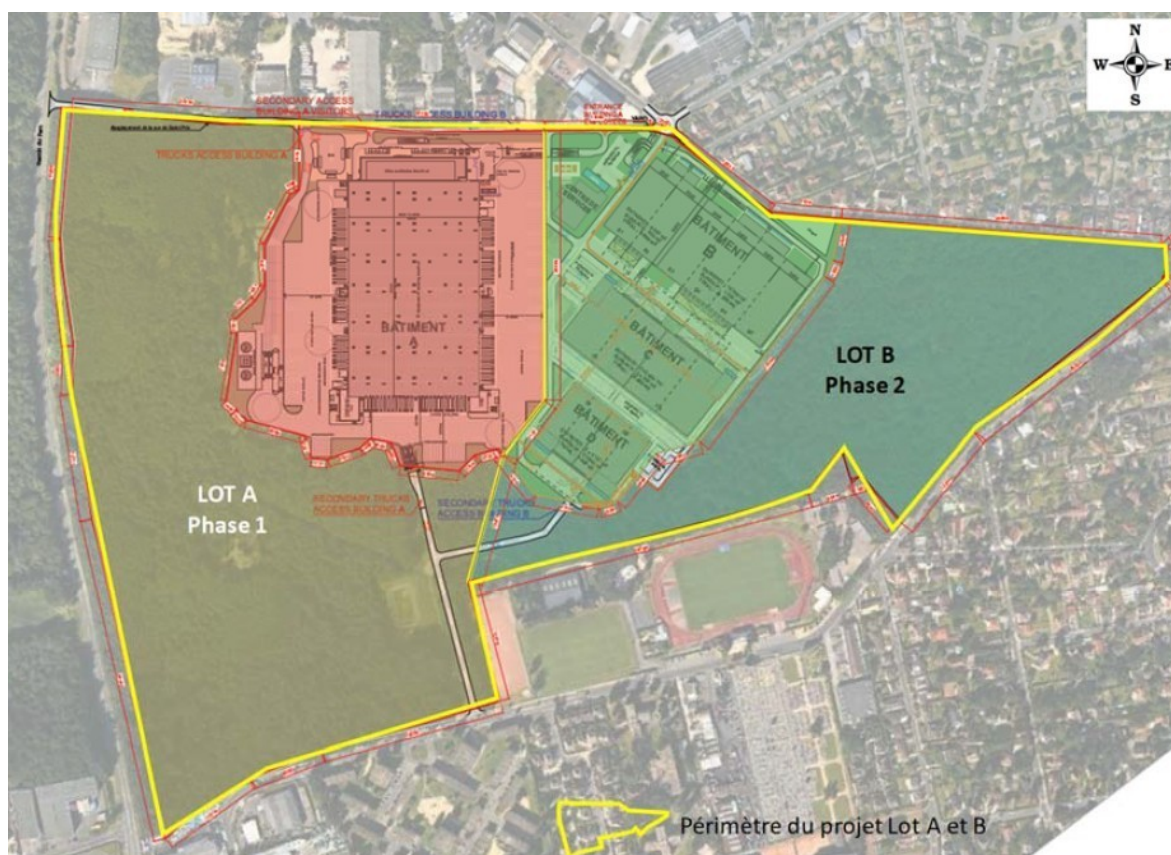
Plan masse à l'échelle du terrain d'assiette.
